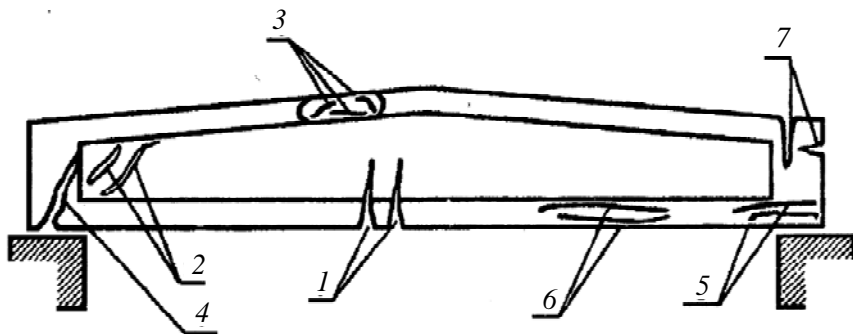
Картина трещинообразования в предварительно напряженной стропильной балке:
